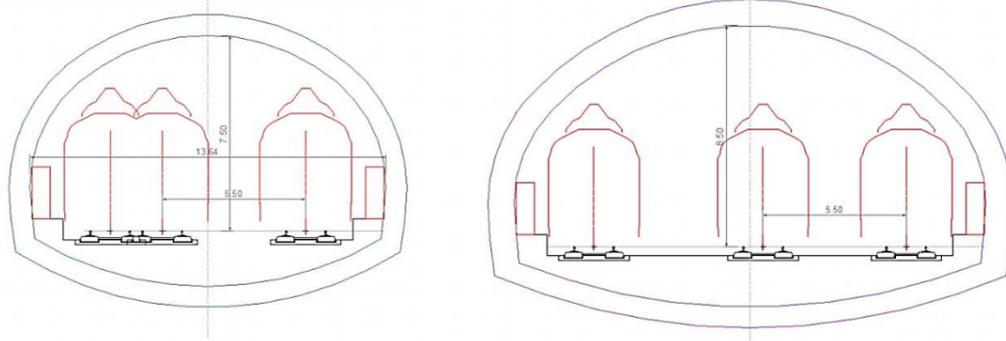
Sections des ouvrages élémentaires de type 3 & 4
